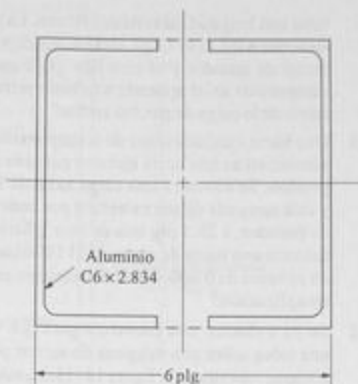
Sección transversal de columna compuesta del problema 14-14.
